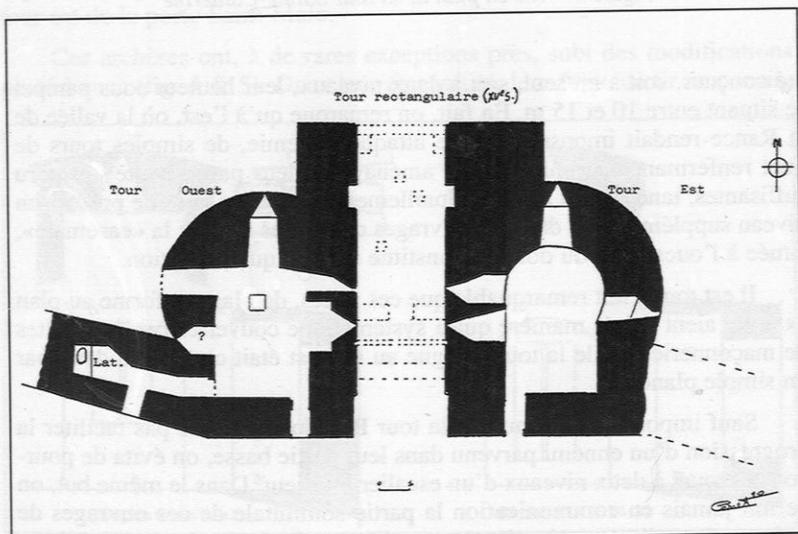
Vue en plan du premier niveau de la porte Saint-Malo.
